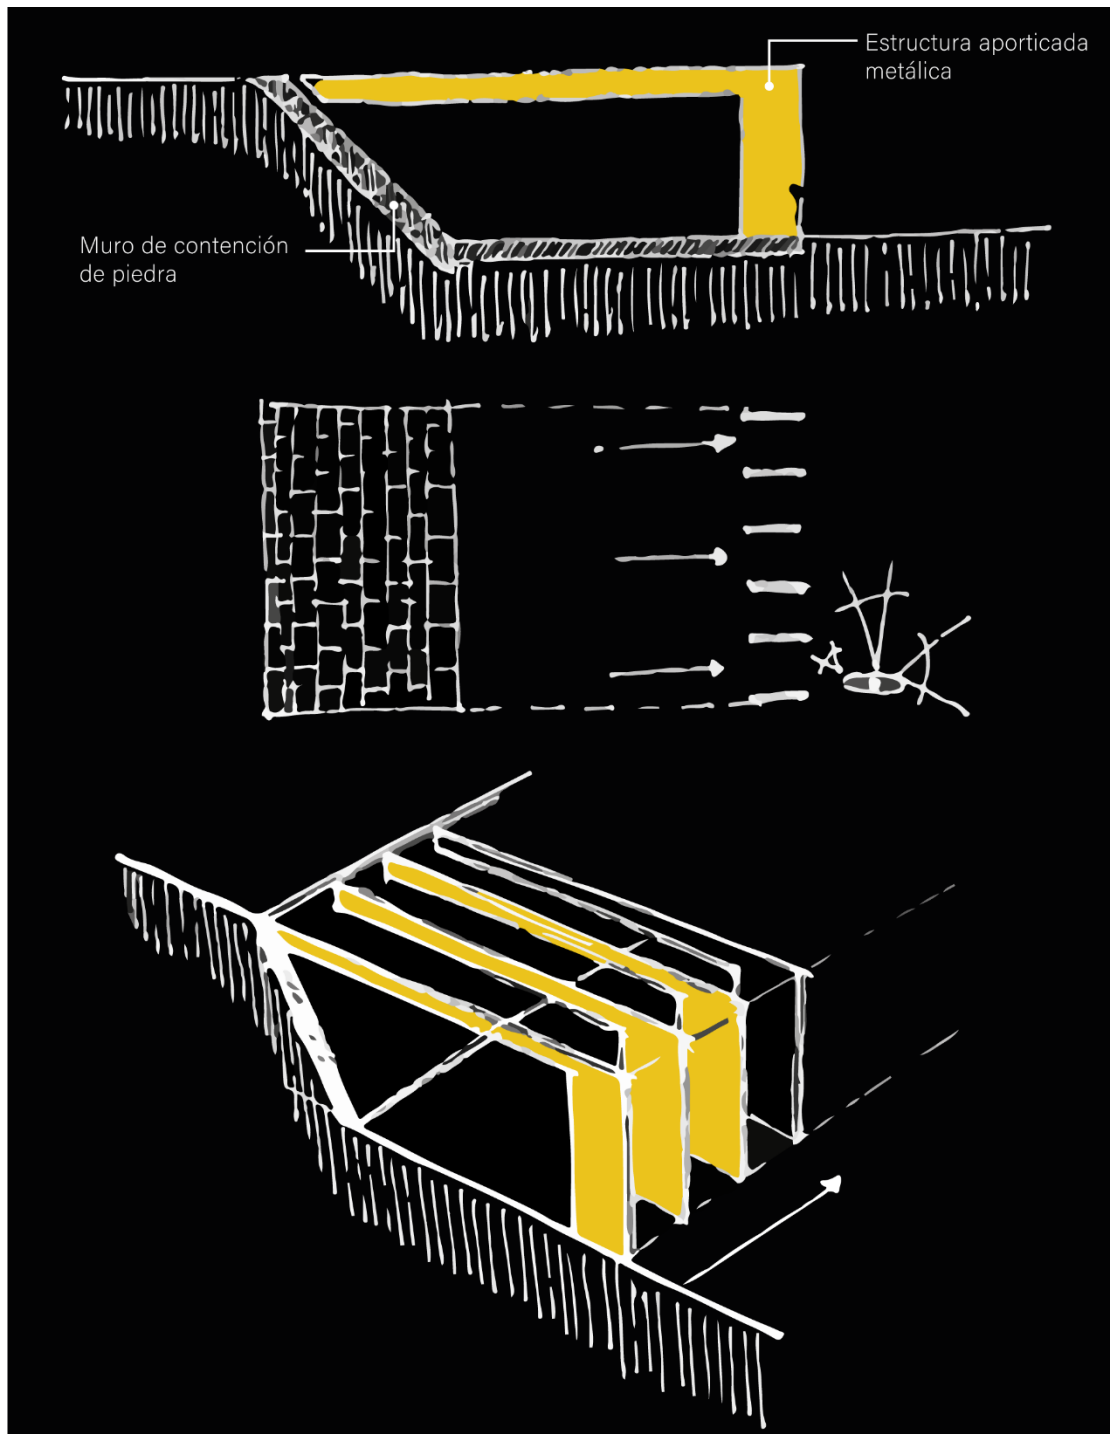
Esquema de estrategia arquitectónica: estructura y sistema constructivo; elaborado por Verdugo, X. 2020
